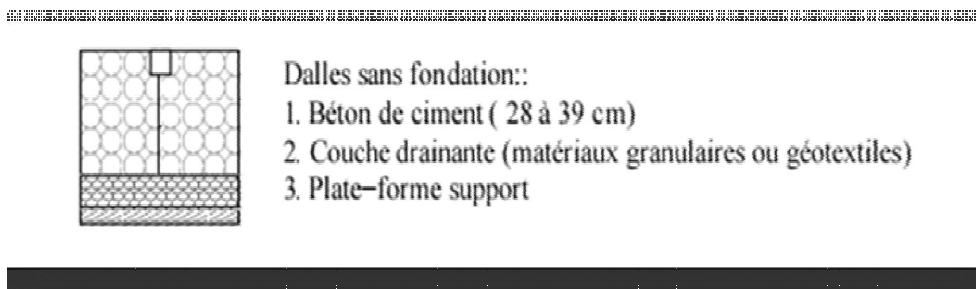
Dalles sans fondation [LCPC, 1994] [1]
